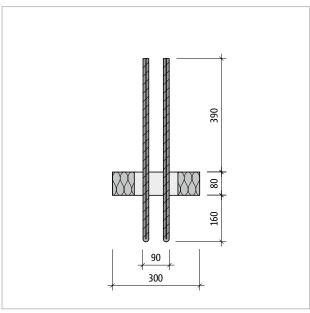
Schöck Sconnex® type W-N-VH: coupe B-B du produit
